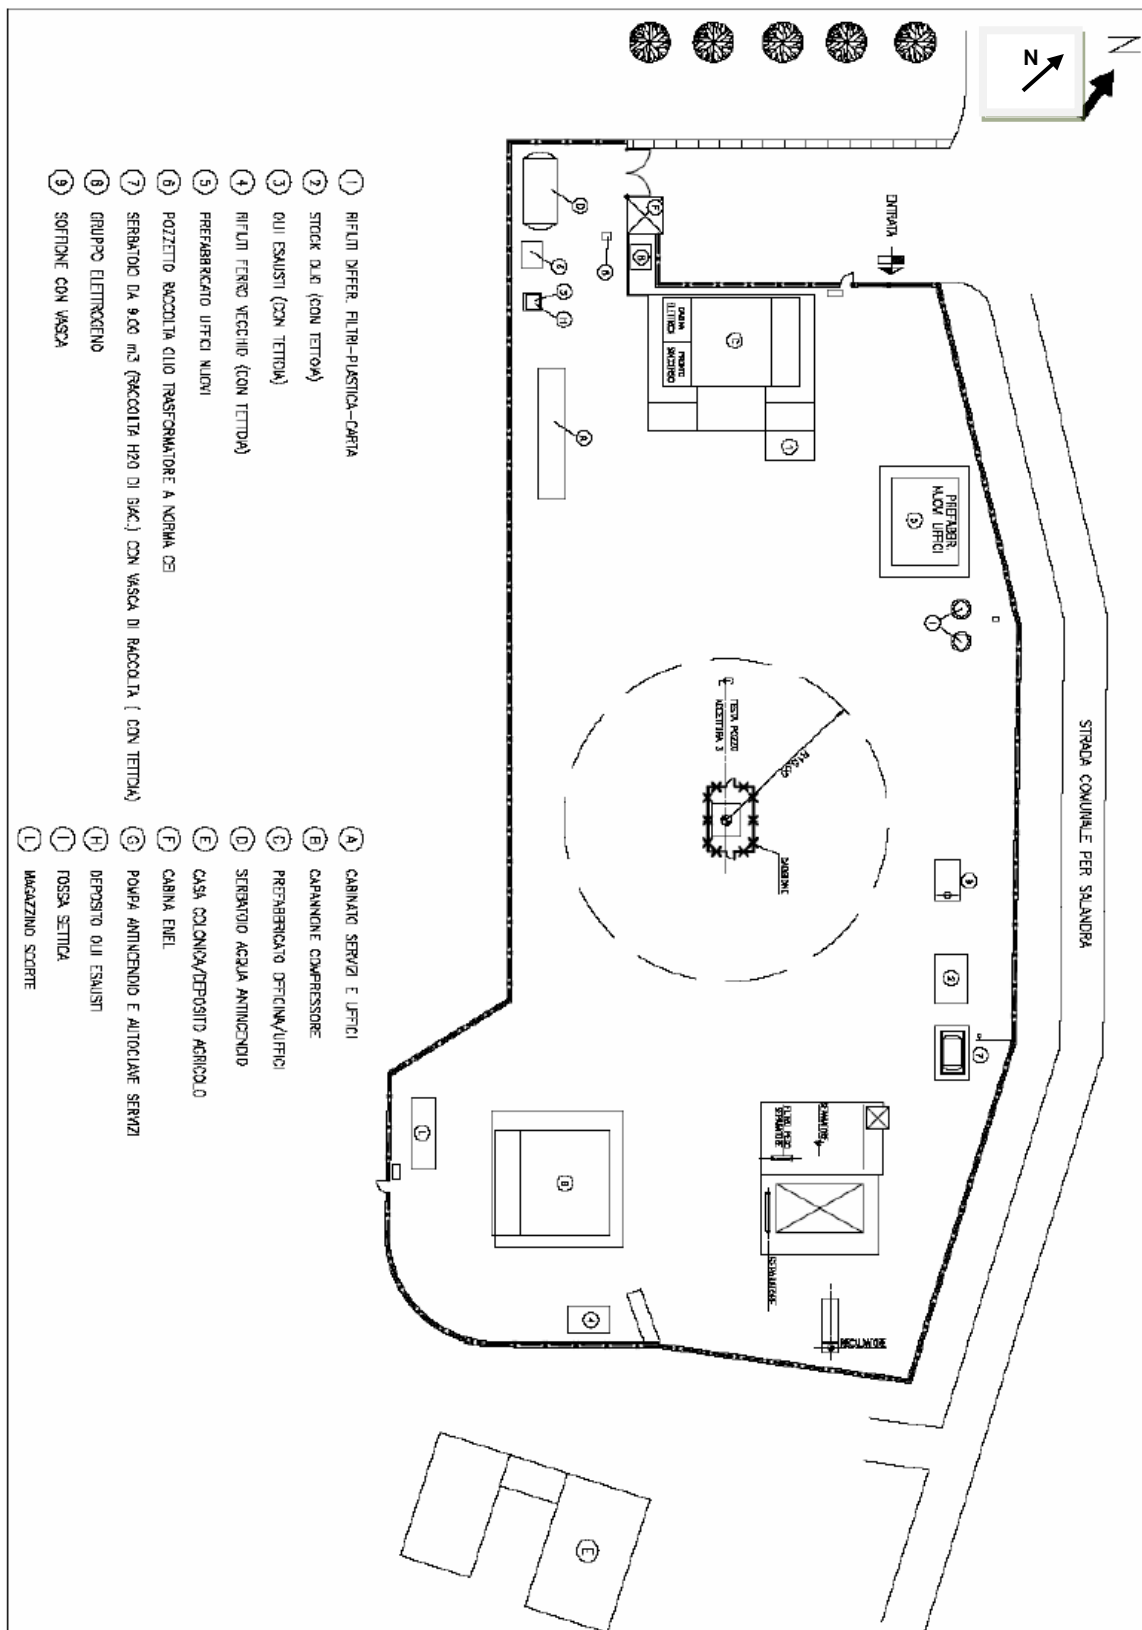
Planimetria Antincendio Sicurezze della Centrale (pozzo-AC 3)
